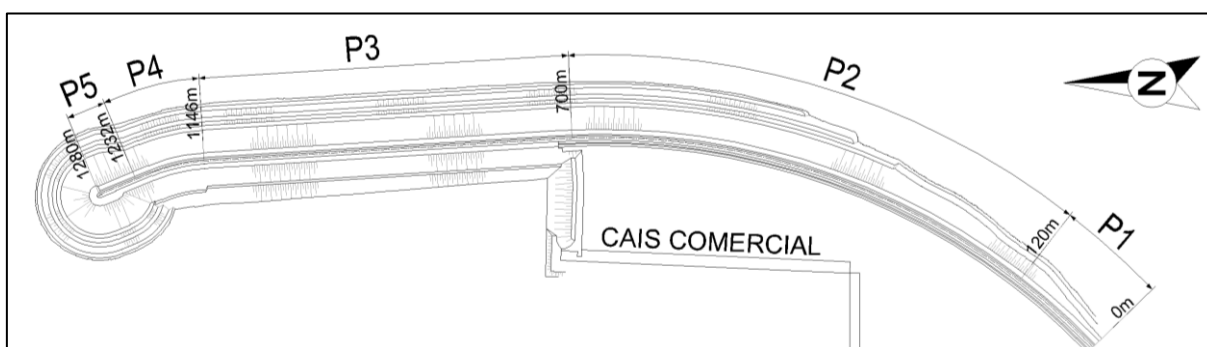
Esquema da Planta do Molhe Sul, construído em 1985
